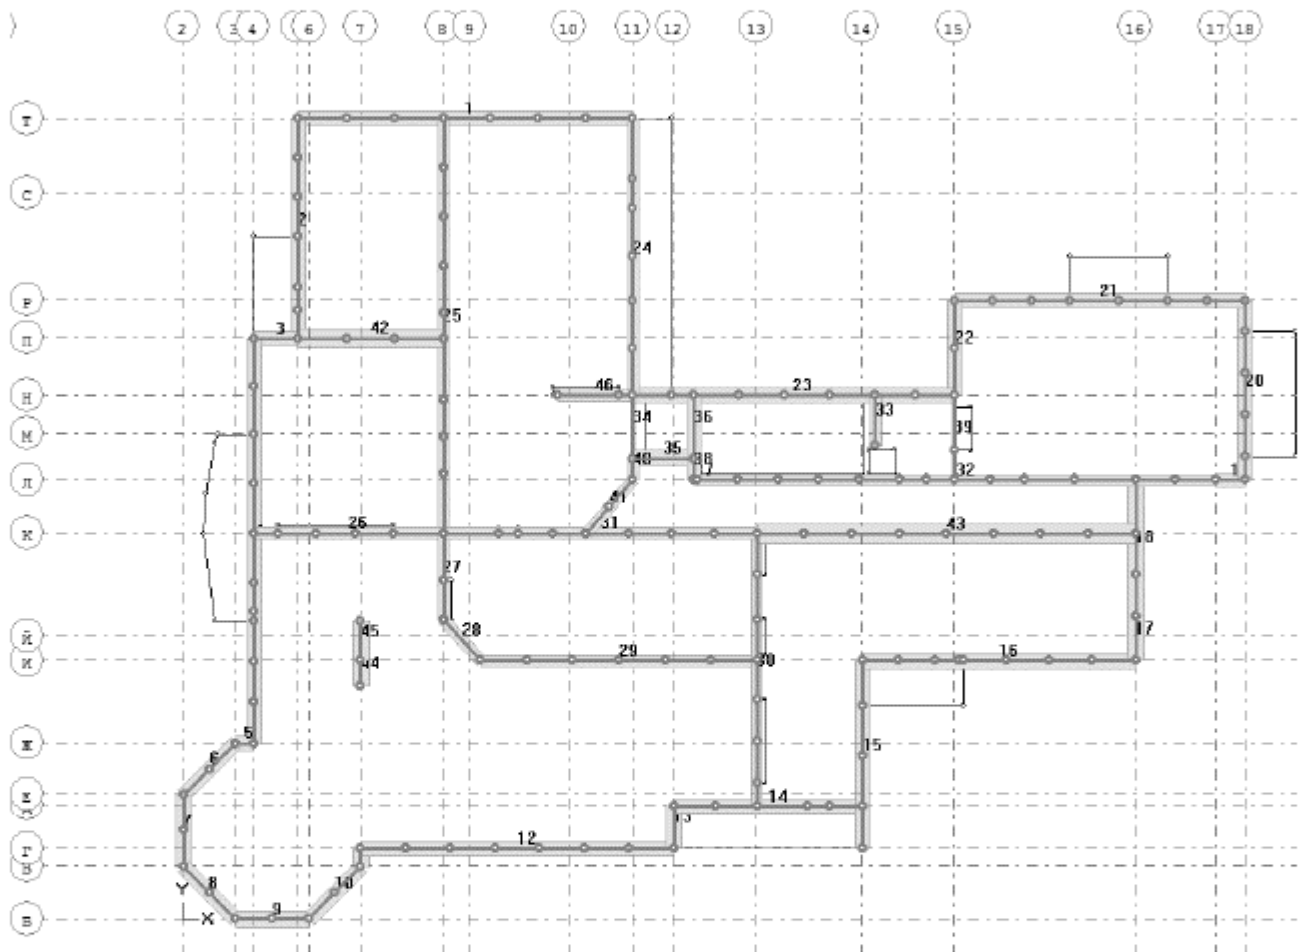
Опалубочне креслення плити перекриття з нумерацією стін
